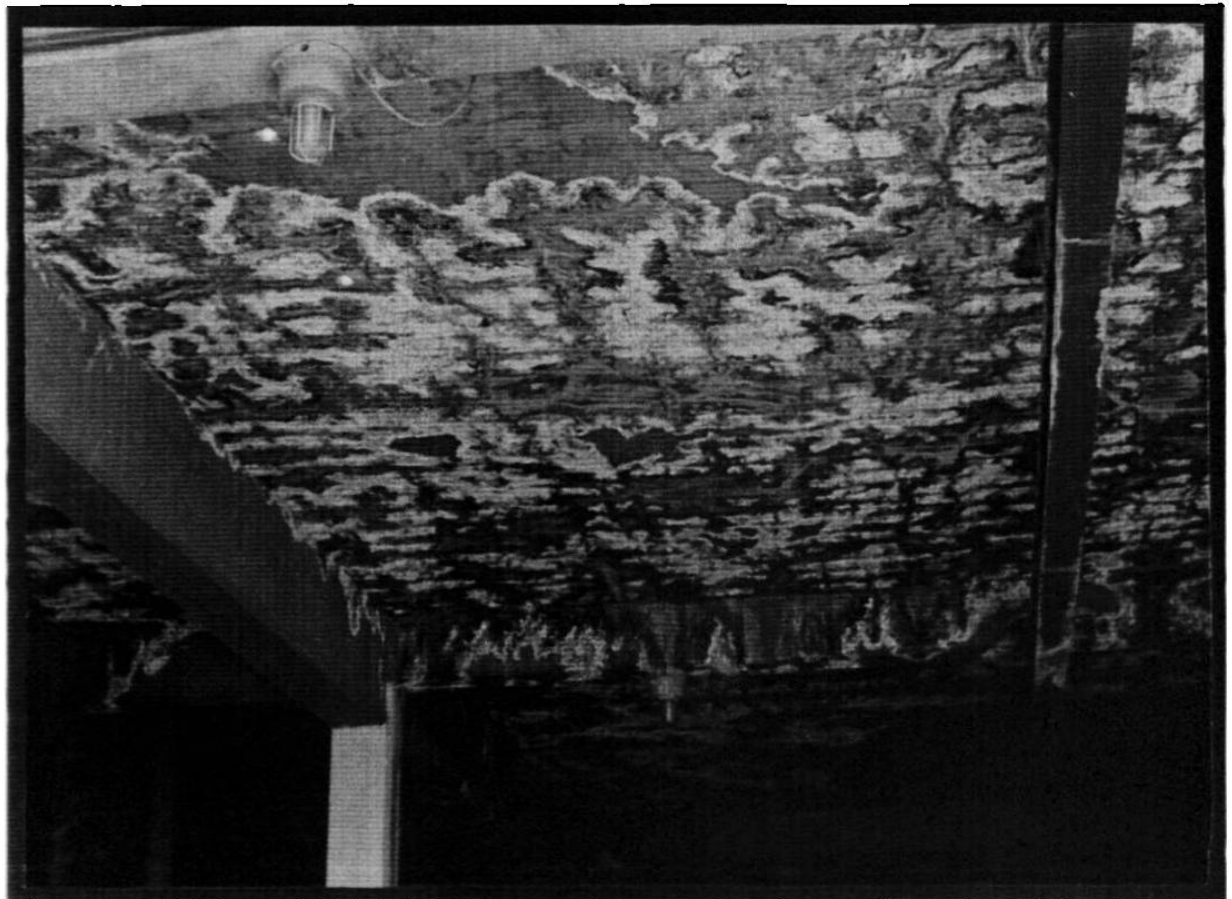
Losa con problemas de lixiviaciones debido a su alta permeabilidad. Aquí se pueden apreciar las eflorescencias en gran parte de su área
